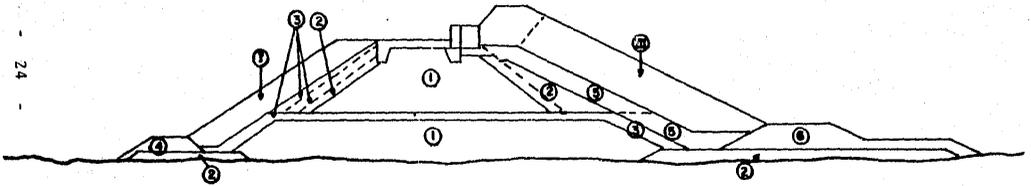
Tipo de roca y bloques de concreto en secciones V y VI
